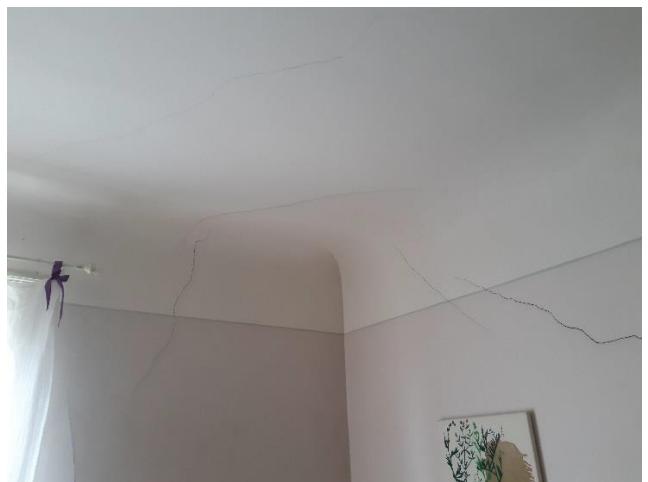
plaisu tīkls telpas nr.37 giestos
